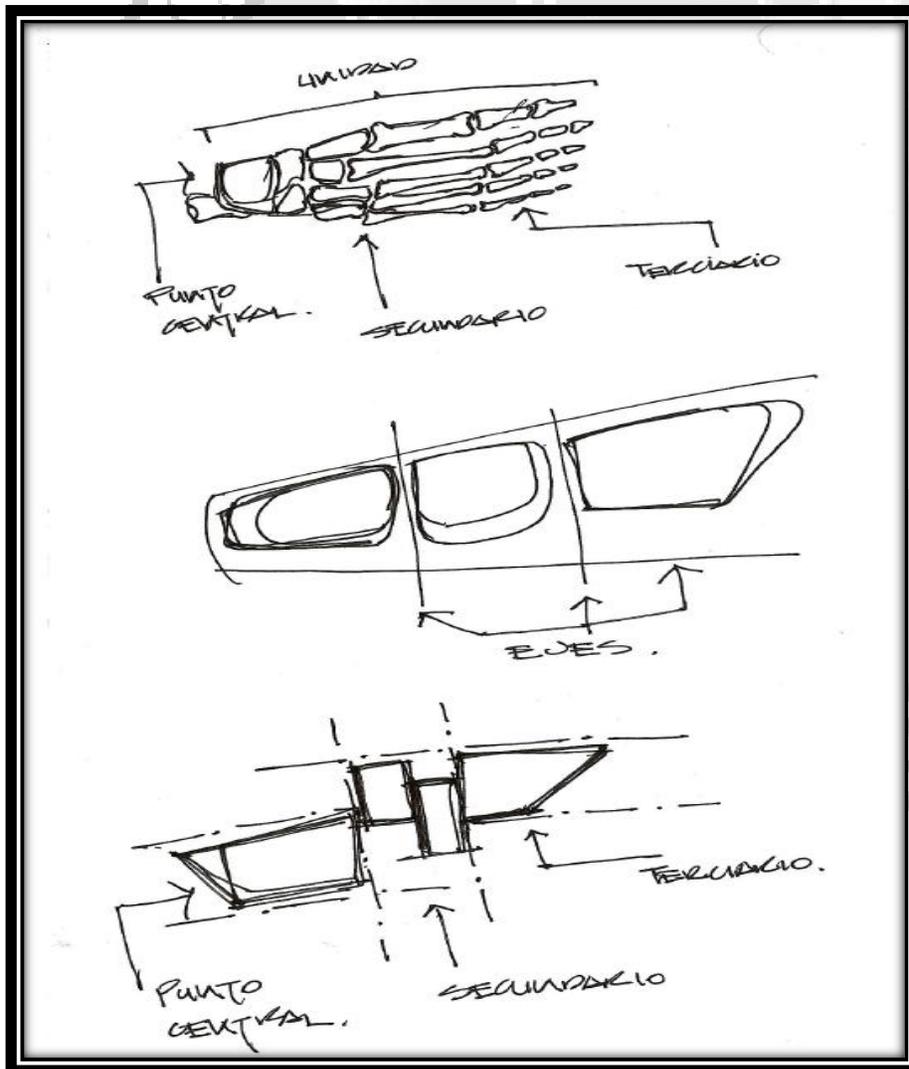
Sketch diseño en planta del Edificio.----Elaboración Propia
